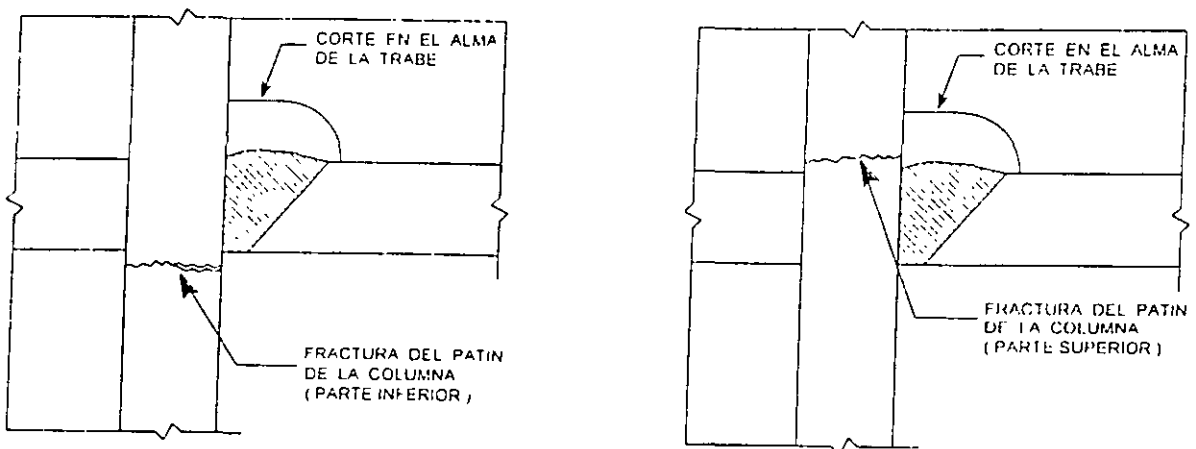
Fractura del patín de la columna en la parte inferior y en la parte superior de la soldadura.
